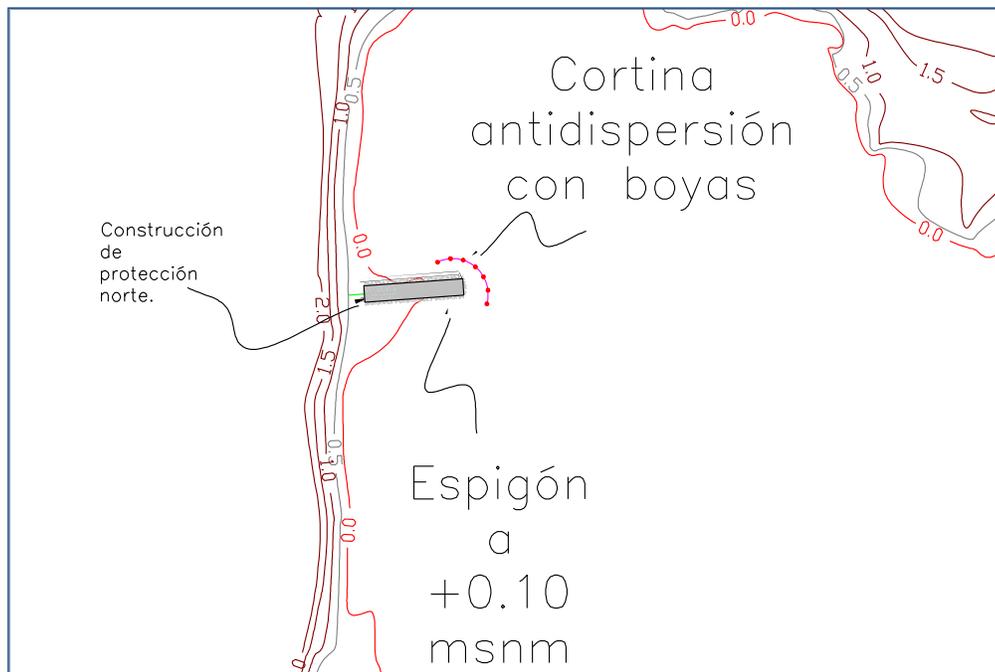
Detalle de la construcción del Espigón al norte de la playa artificial.
